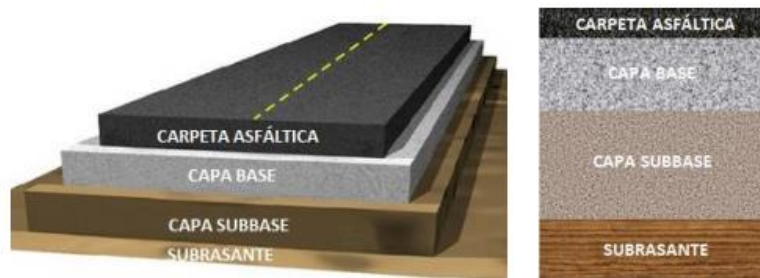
Estructura del paquete estructural de un pavimento Asfáltico [22].
